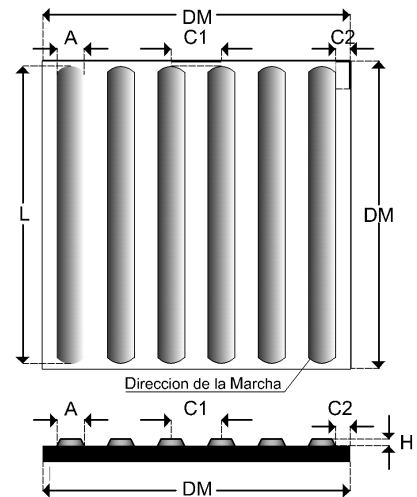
b.- Pavimento de Guía de Dirección. FIG. 10 b
